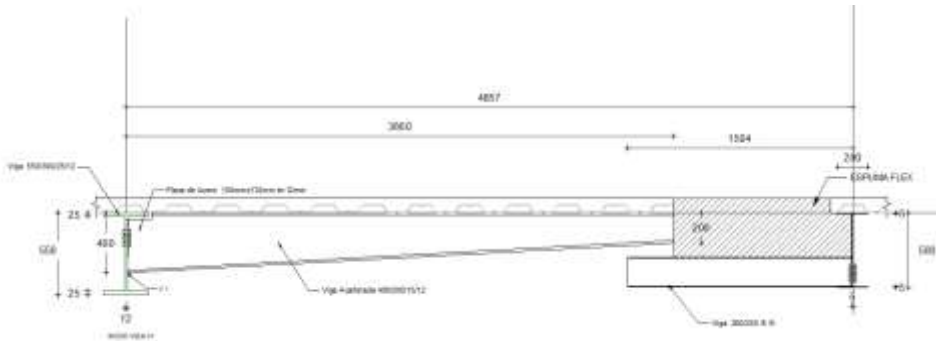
Junta de construcción entre el voladizo y el ascensor recubierta con espuma Flex.
